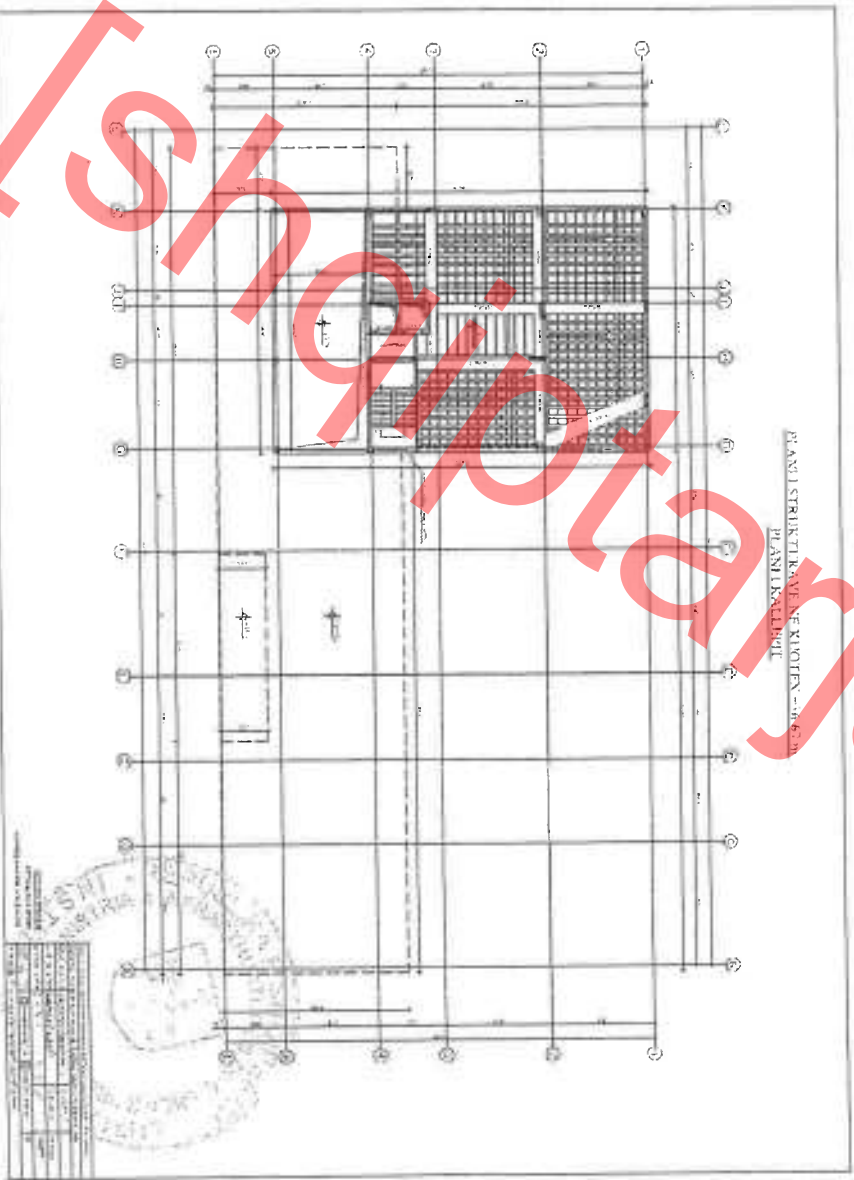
Plani i Strukturave ne Kuoten +36.67 m, Plani i Kallepit
